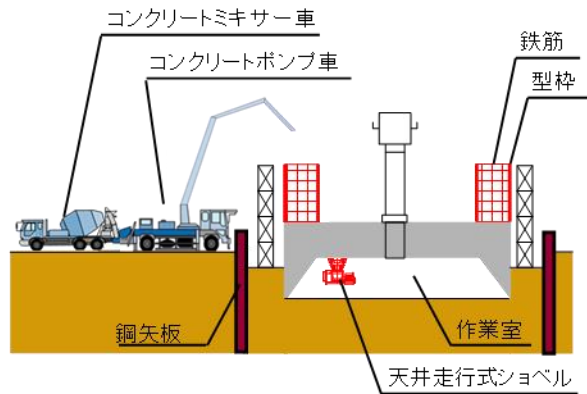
(1) 下部工（ニューマチックケーソン基礎）の施工手順
